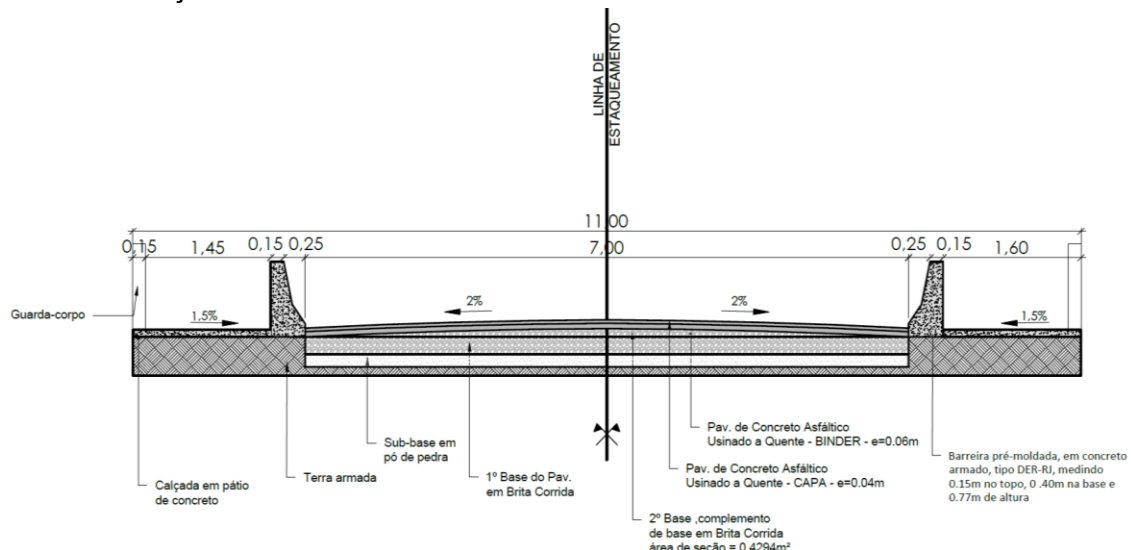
SEÇÃO TIPO PAVIMENTO - TERRA ARMADA
